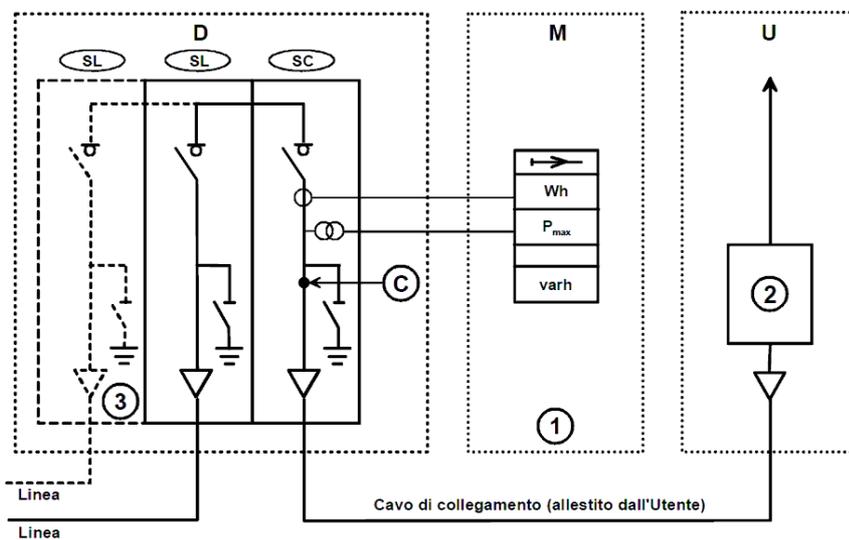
Schema di collegamento fra la cabina consegna e impianto di Utente passivo
